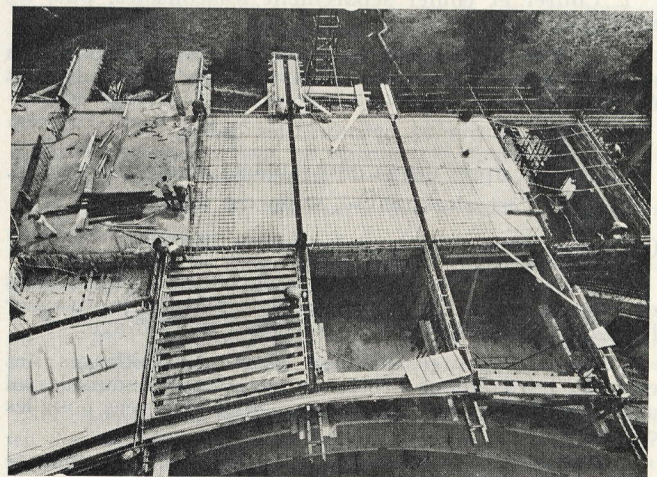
Bétonnage des consols et du plancher haut du cinquième étage.
